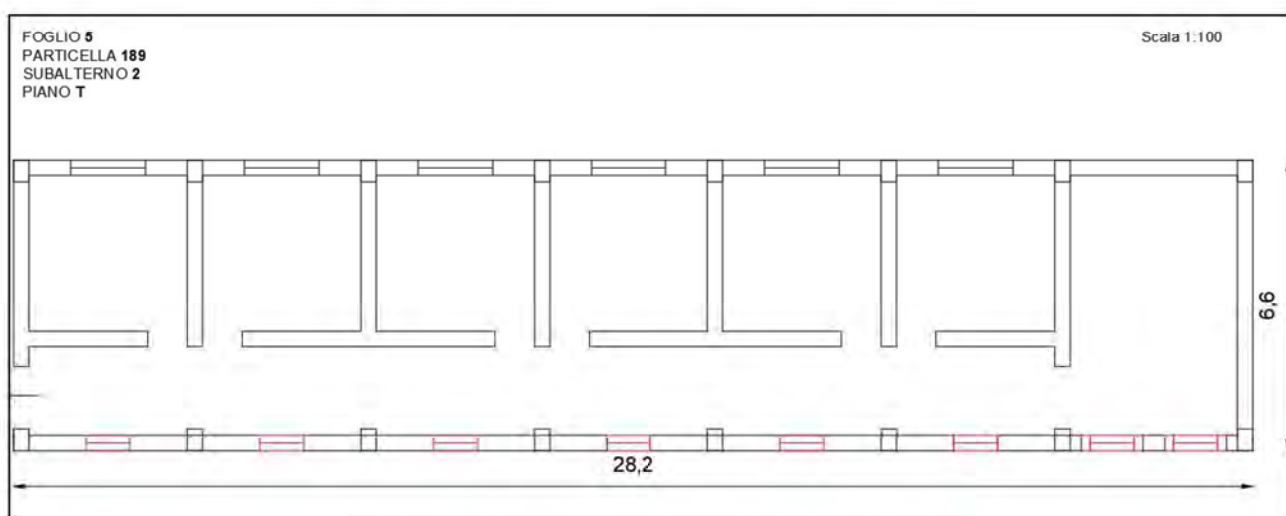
Planimetria incongruenze catastali Sub 2- Piano0
